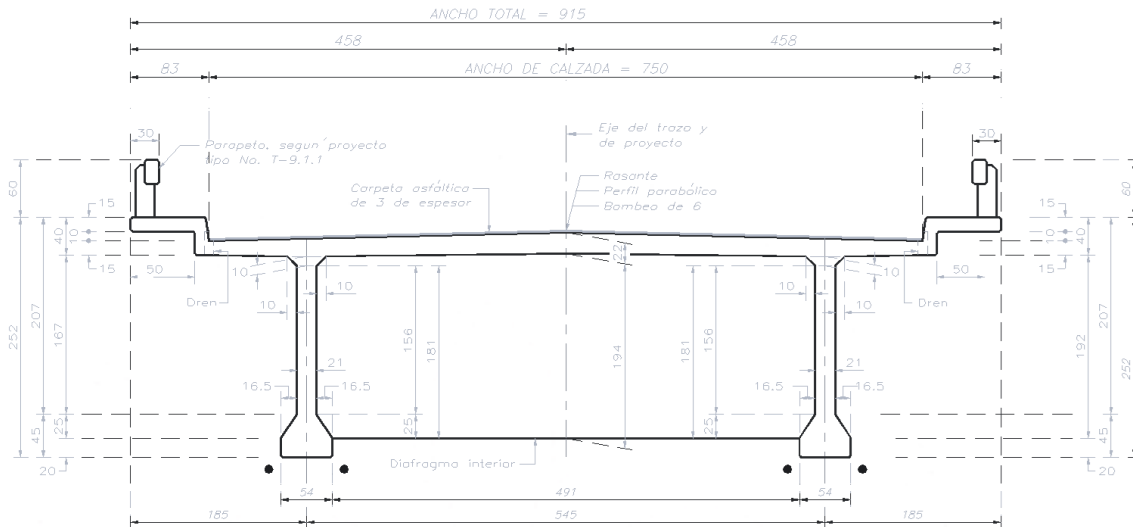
Superestructura existente, sección transversal. (autoría propia anexo B)
